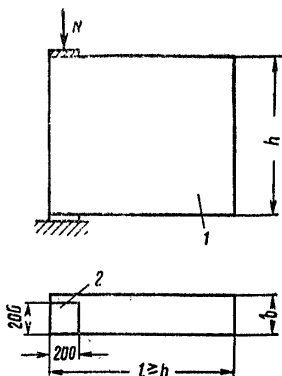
Схема приложения нагрузки при испытании опорных частей панели
